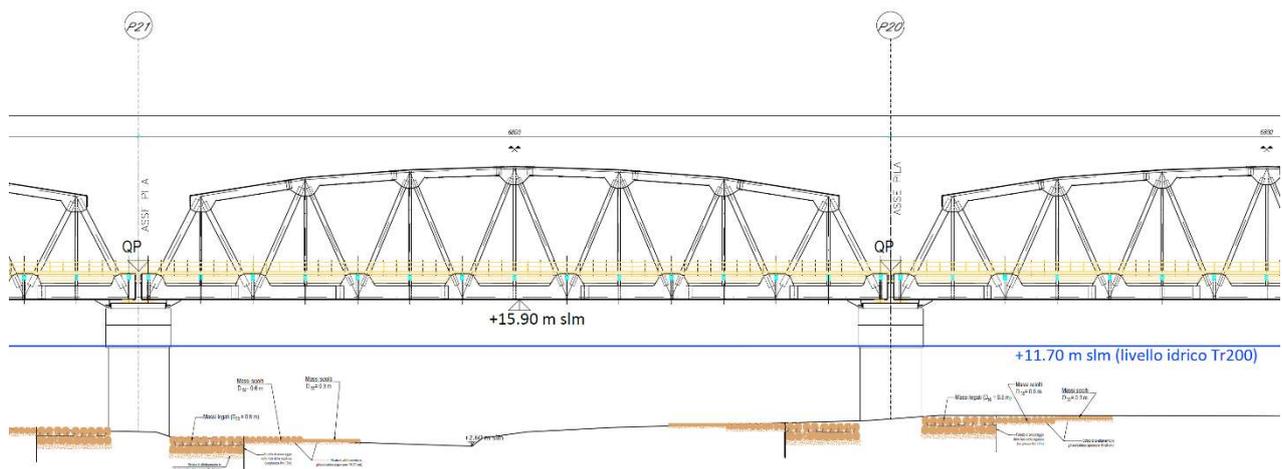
Fiume Isonzo, opere di protezione previste attorno alle pile in alveo.
